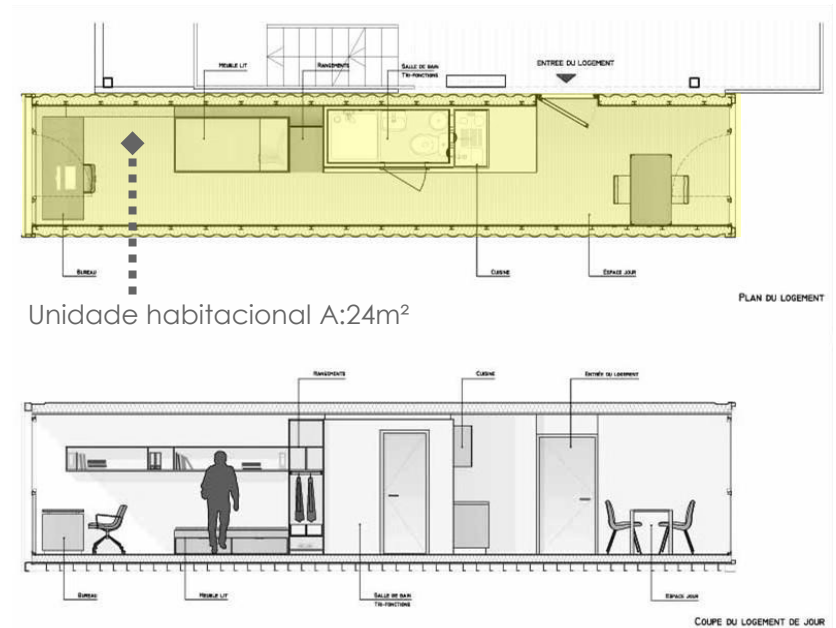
Planta e corte da habitação | Fonte: contemporist.com
